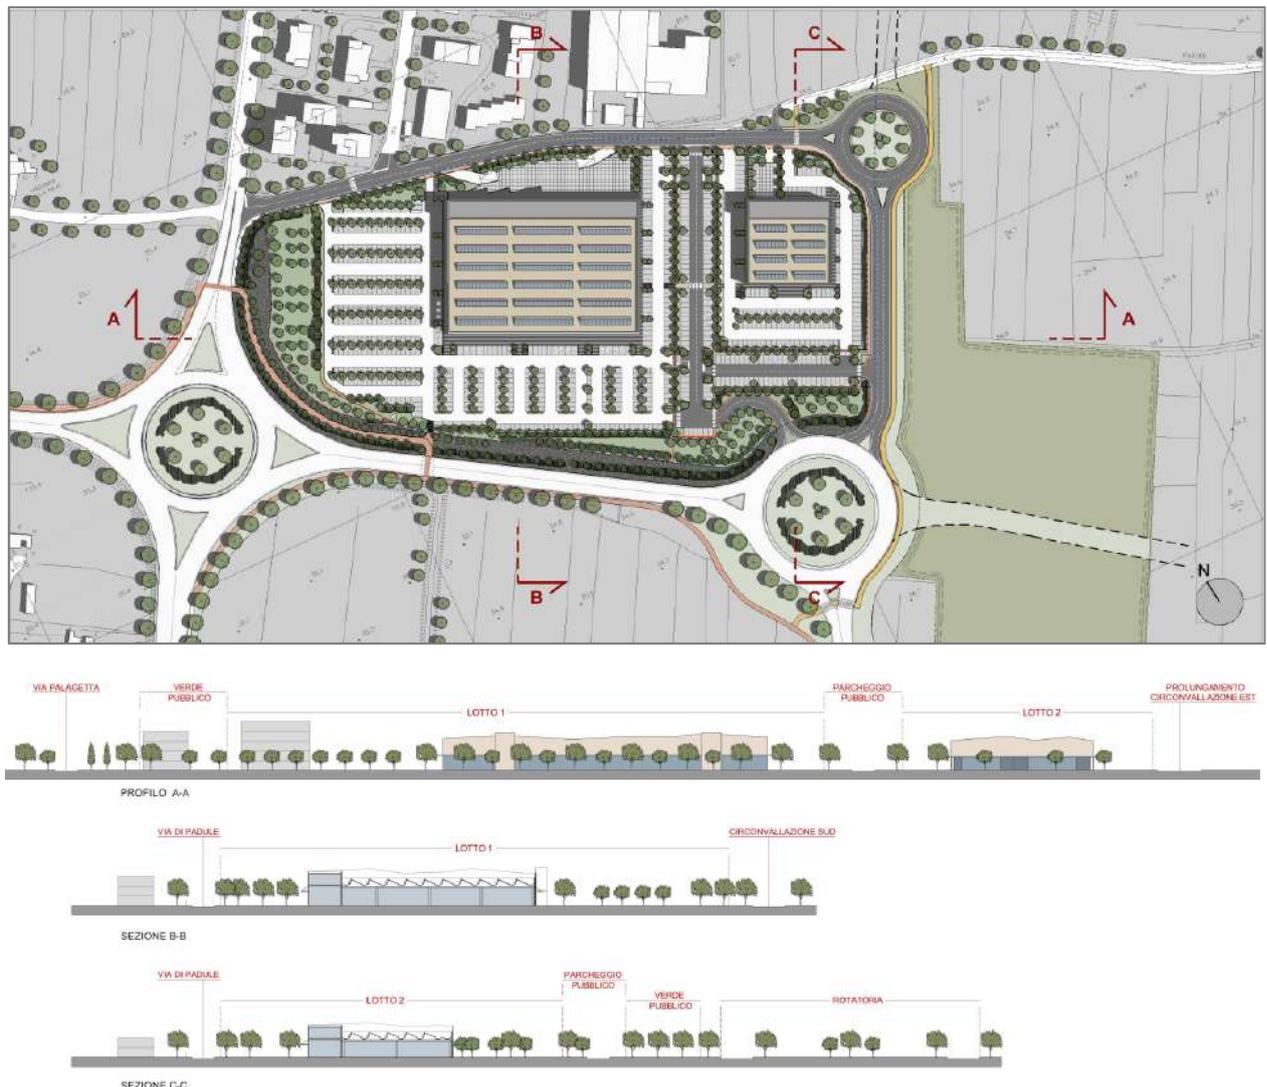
Profili e Sezioni (tav. C 9) (Fonte: Proposta di assetto urbanistico del P.A.)
